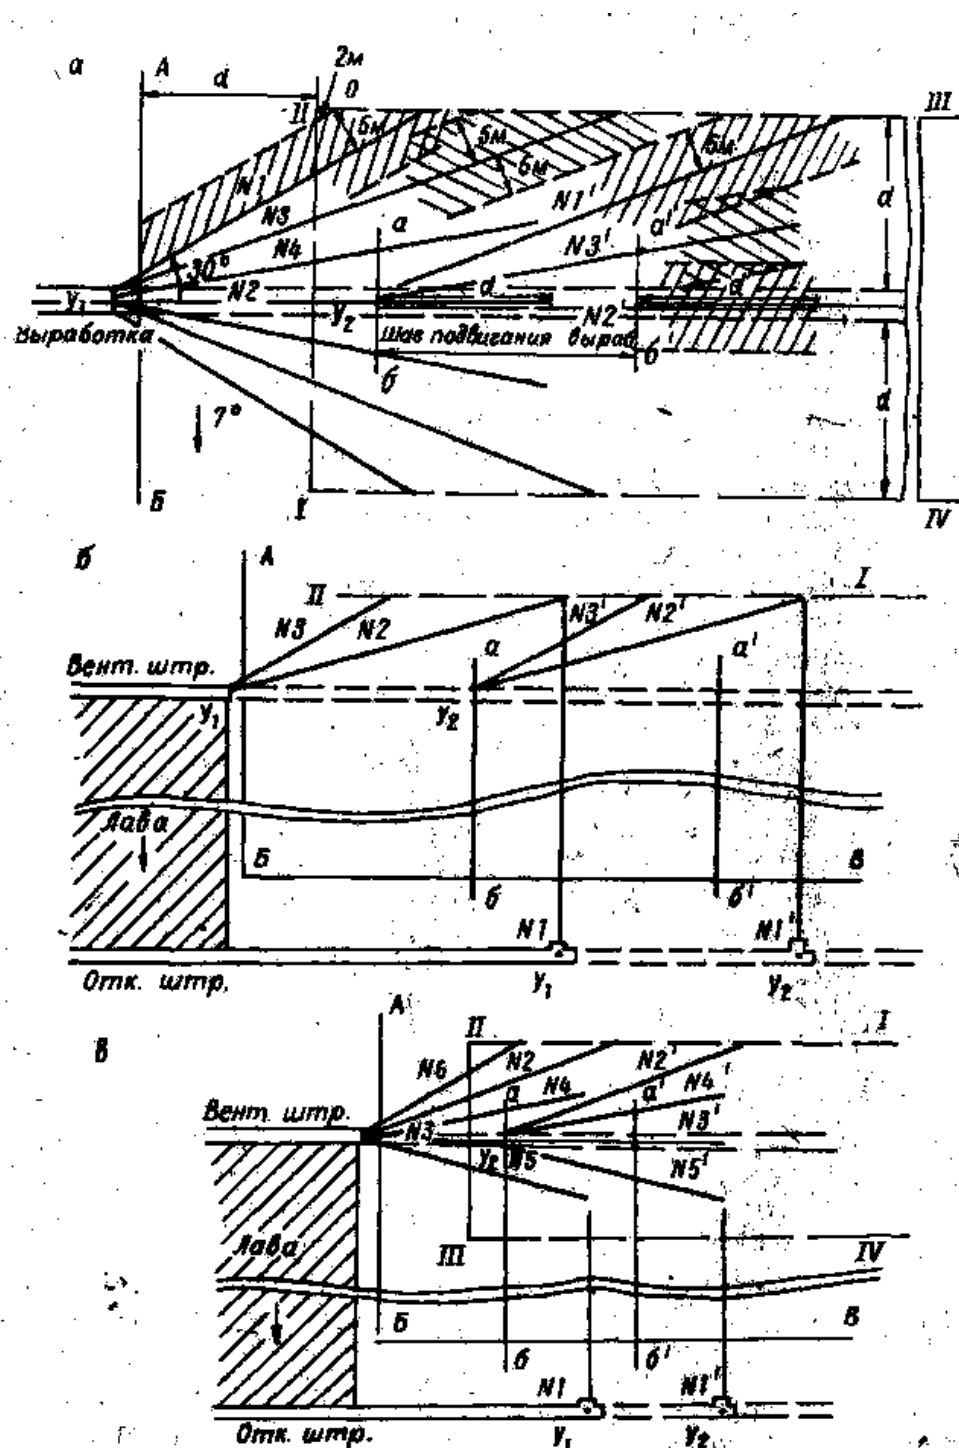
Схеми розташування випереджаючих свердловин [12]
